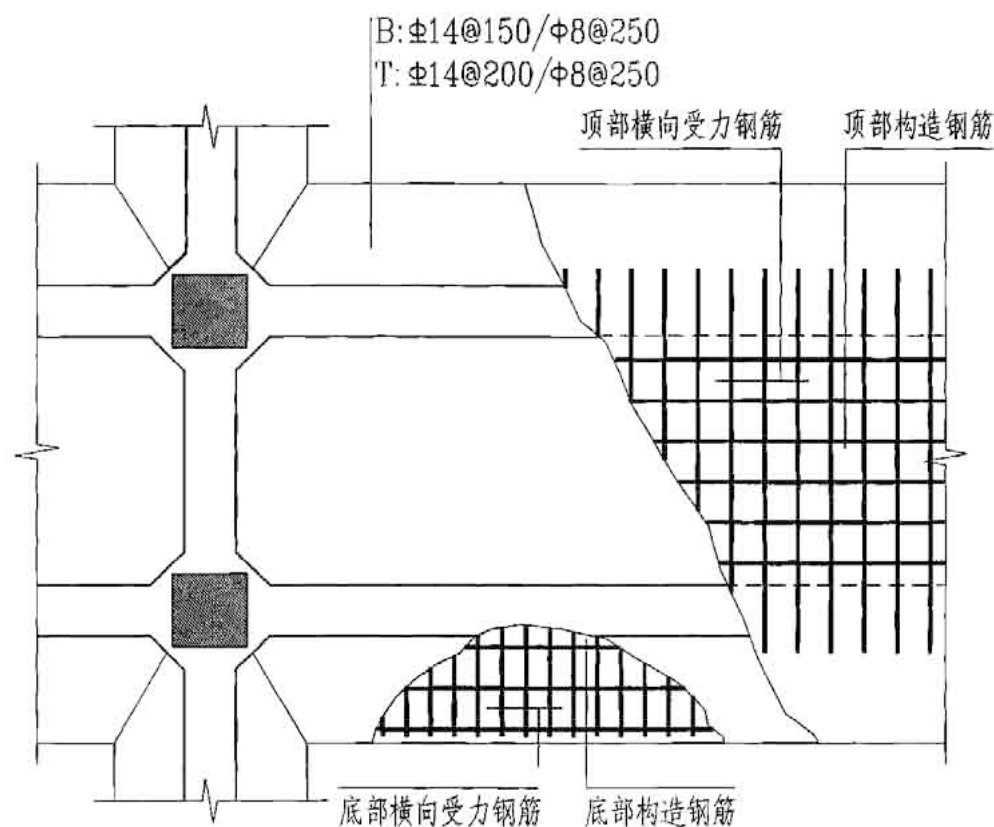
双梁条形基础底板顶部配筋示意
